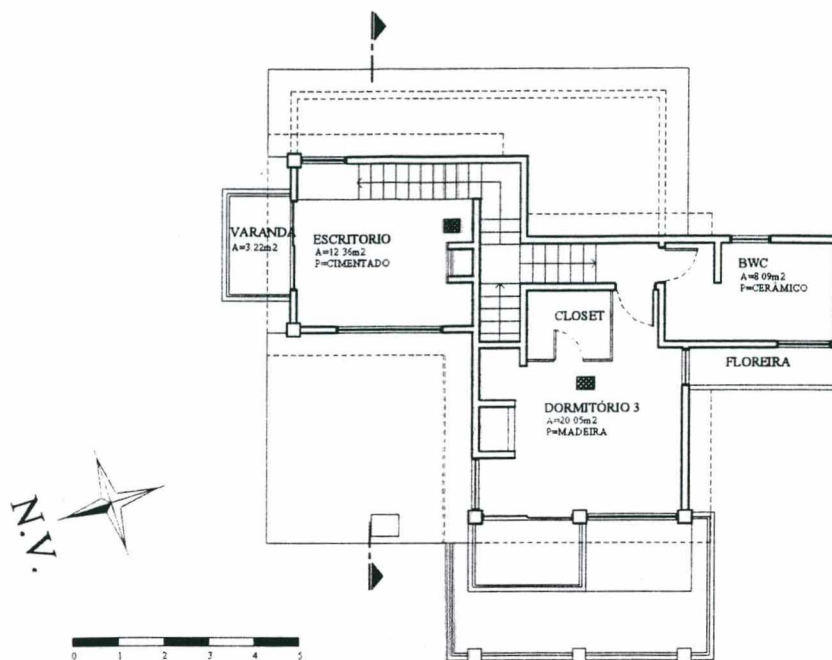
Planta Baixa Pavimento Superior Residência 3
